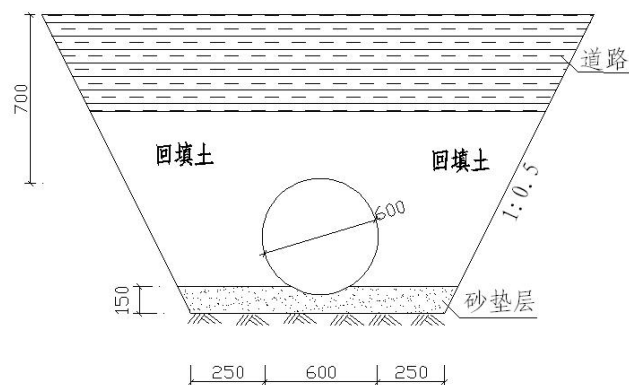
排水管断面结构设计图（引自主设）（单位：mm）
